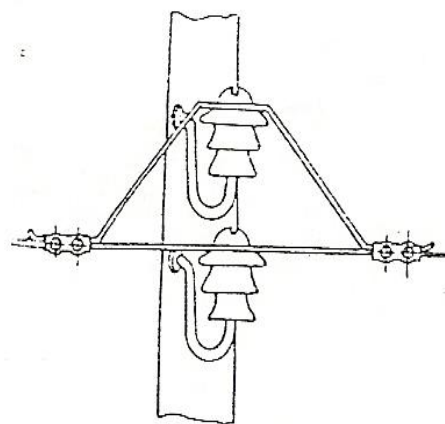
Legătură de siguranță la stâlpi de susținere, cu două izolatoare în plan vertical
